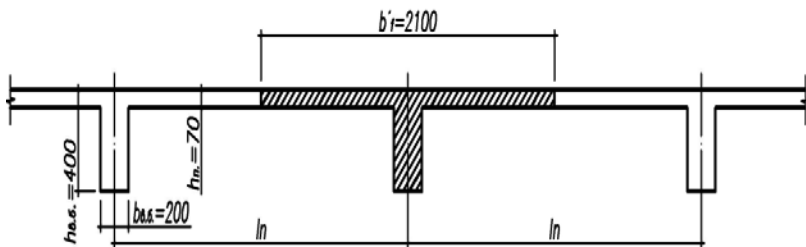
Расчетное сечение второстепенной балки при расчете на положительный изгибающий момент
